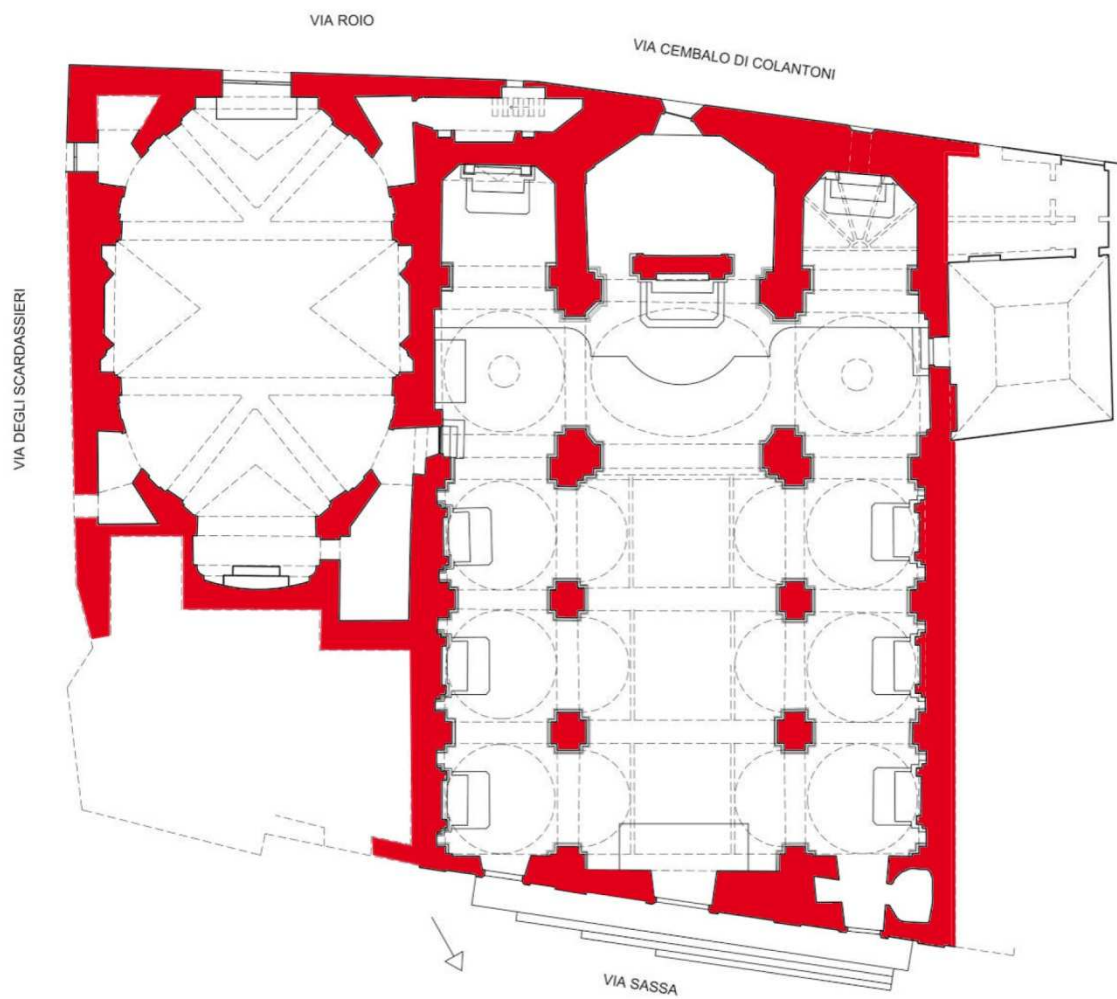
Planimetria dell’oratorio di san Giuseppe dei Minimi a sinistra, a destra l’impianto di san Biagio.
